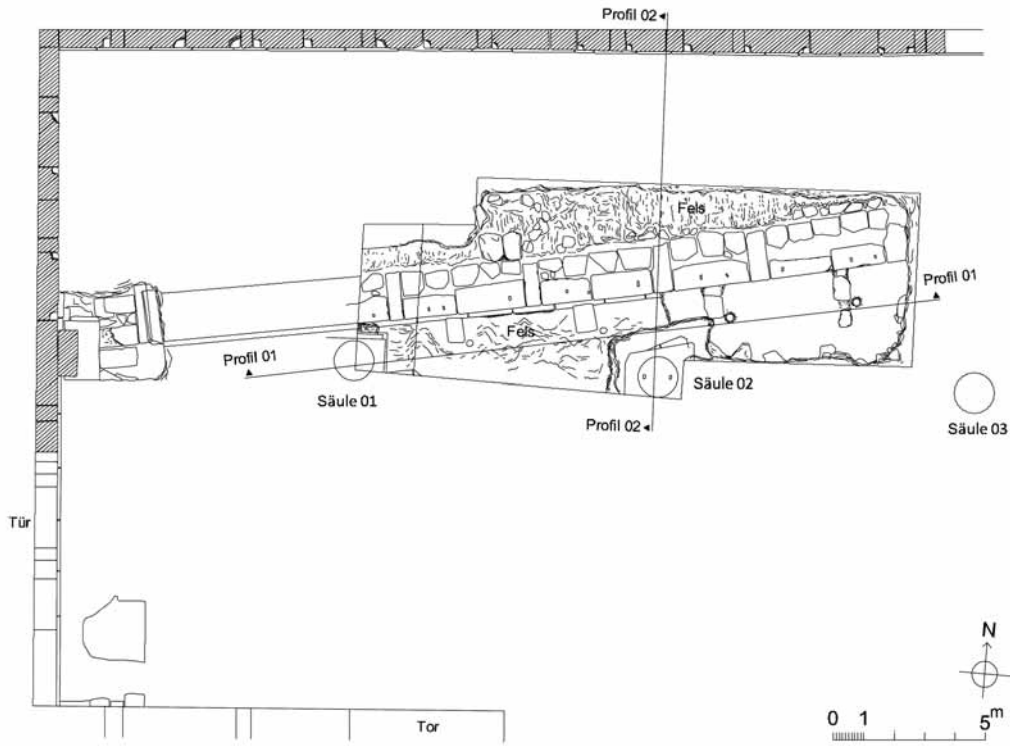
Assos, Agora. Sondage im Westteil der Nordstoa, Mauerreste des Vorgängergebäudes, Grundriss (M. 1 : 250)
